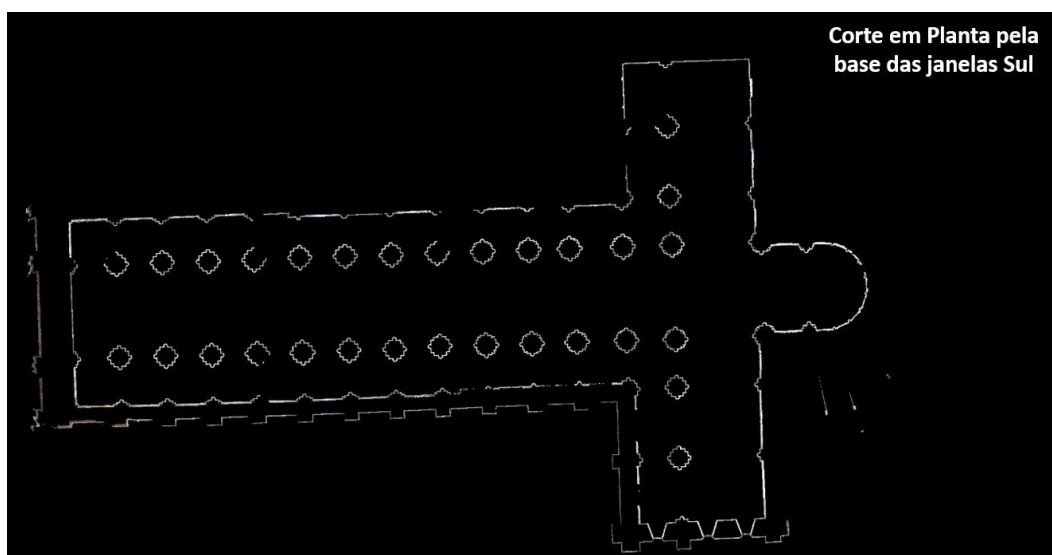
Corte em planta pela base das janelas Sul da Igreja do Mosteiro de Alcobaça.
